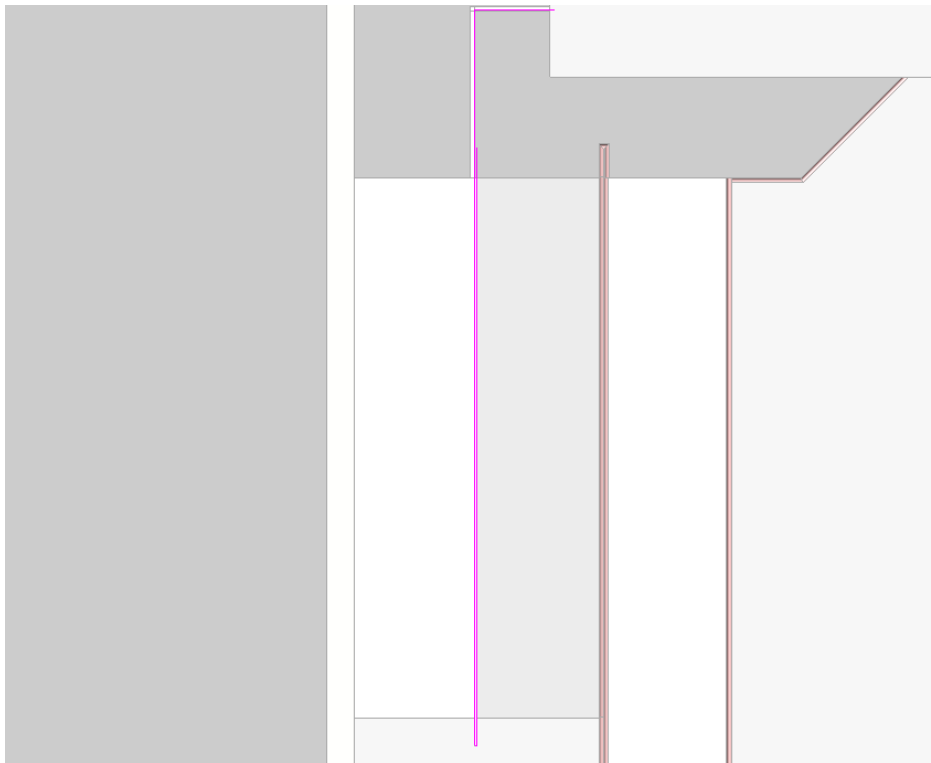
Vista en planta de la edición del camino de barandillas en la rampa en Revit
